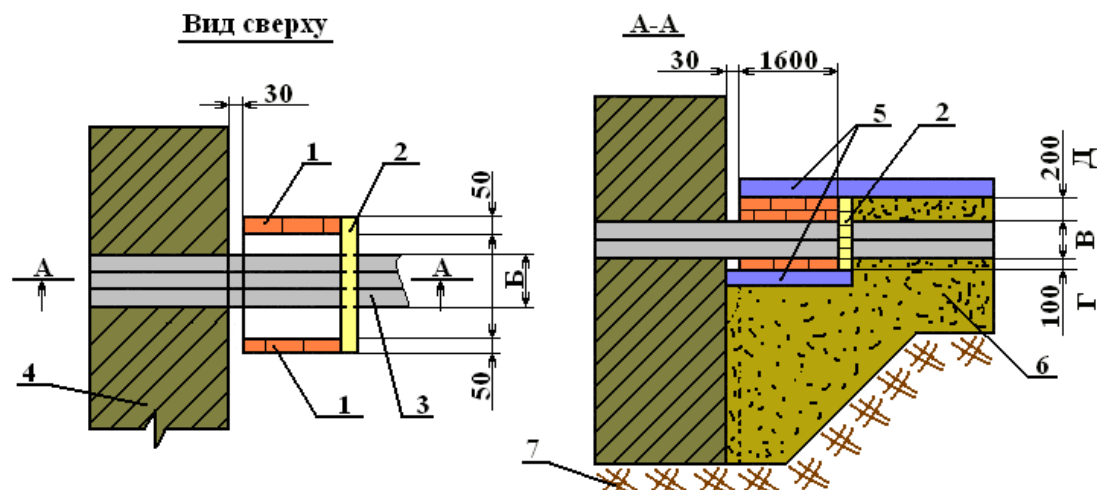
Защита трубы при выходе из фундамента в грунт
